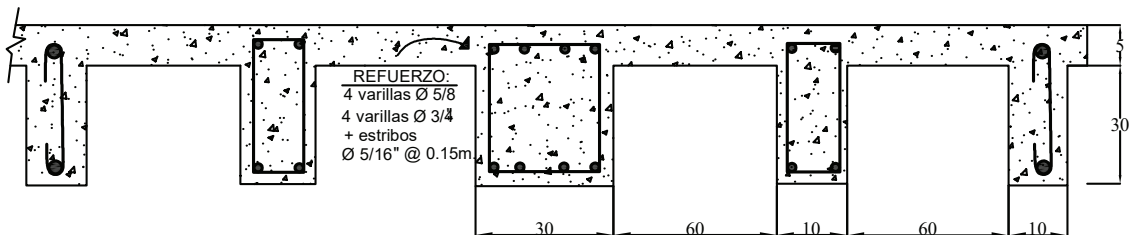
Armado de las nervaduras principales y vigas conexión.
